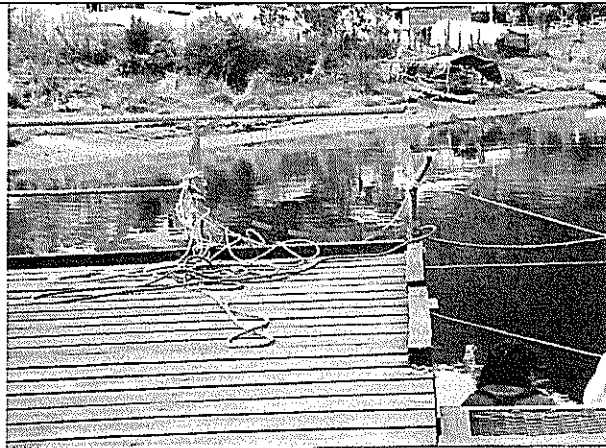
Sector Estero, hundimiento de terreno en costado laguna y muro de hormigón pre existente.
